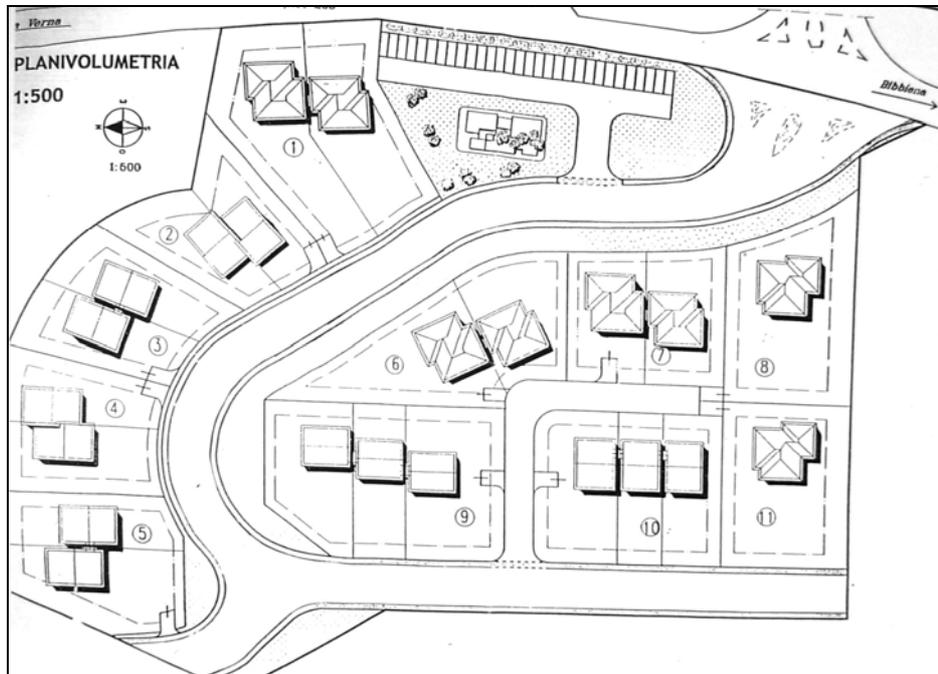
Planivolumetrico. Proposta di piano di lottizzazione presentata nel 2005
